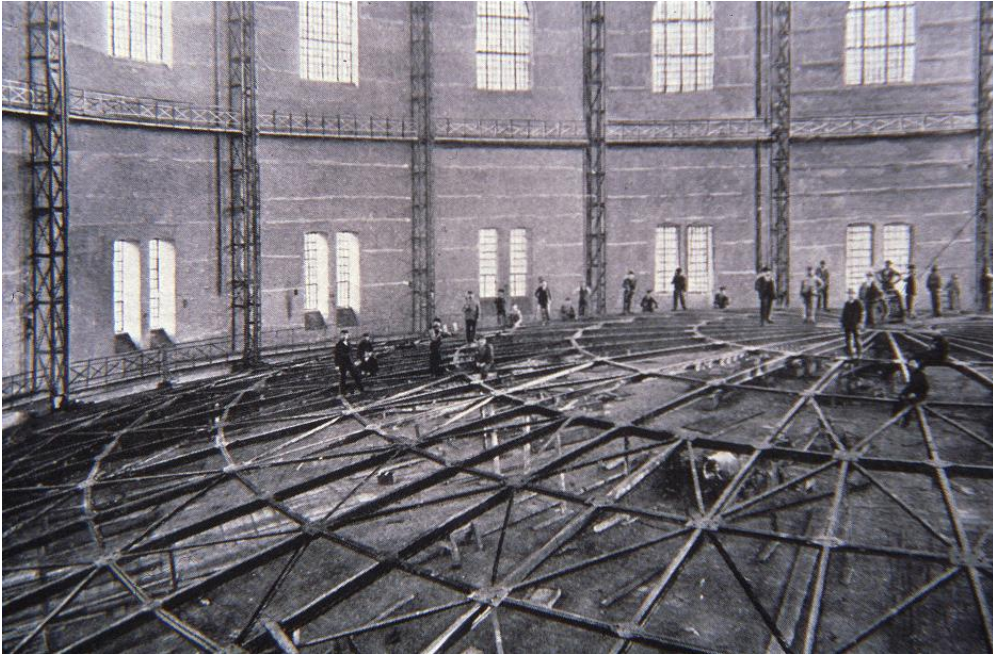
24. Cupola construită în 1885 de Schwelder în Viena pentru înmagazinarea gazului [13]
